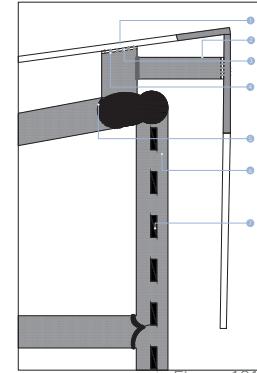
Detalle CF -10, módulo. Elaboración propia, 2024.
